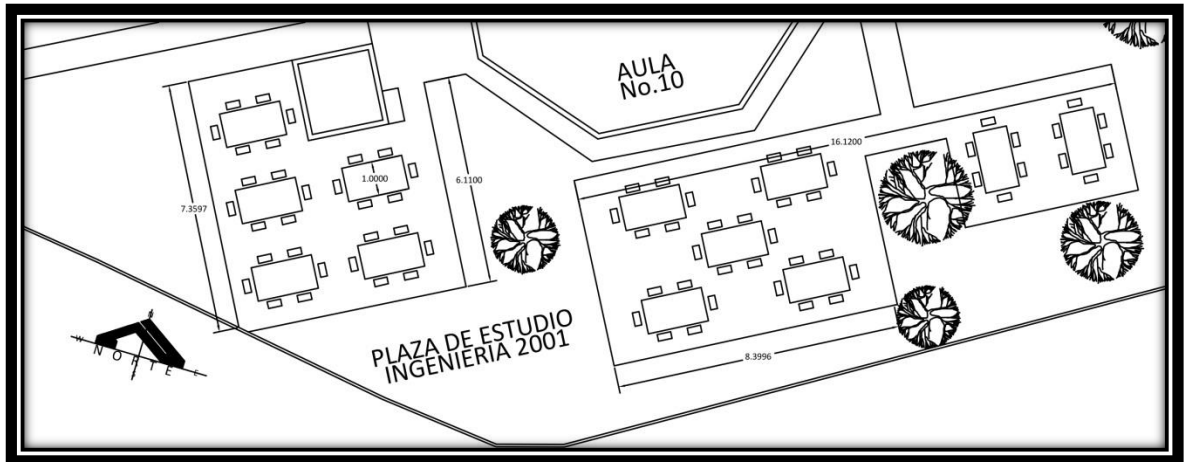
Planta arquitectónica de la actual plaza de estudio "Ingeniería 2001"
